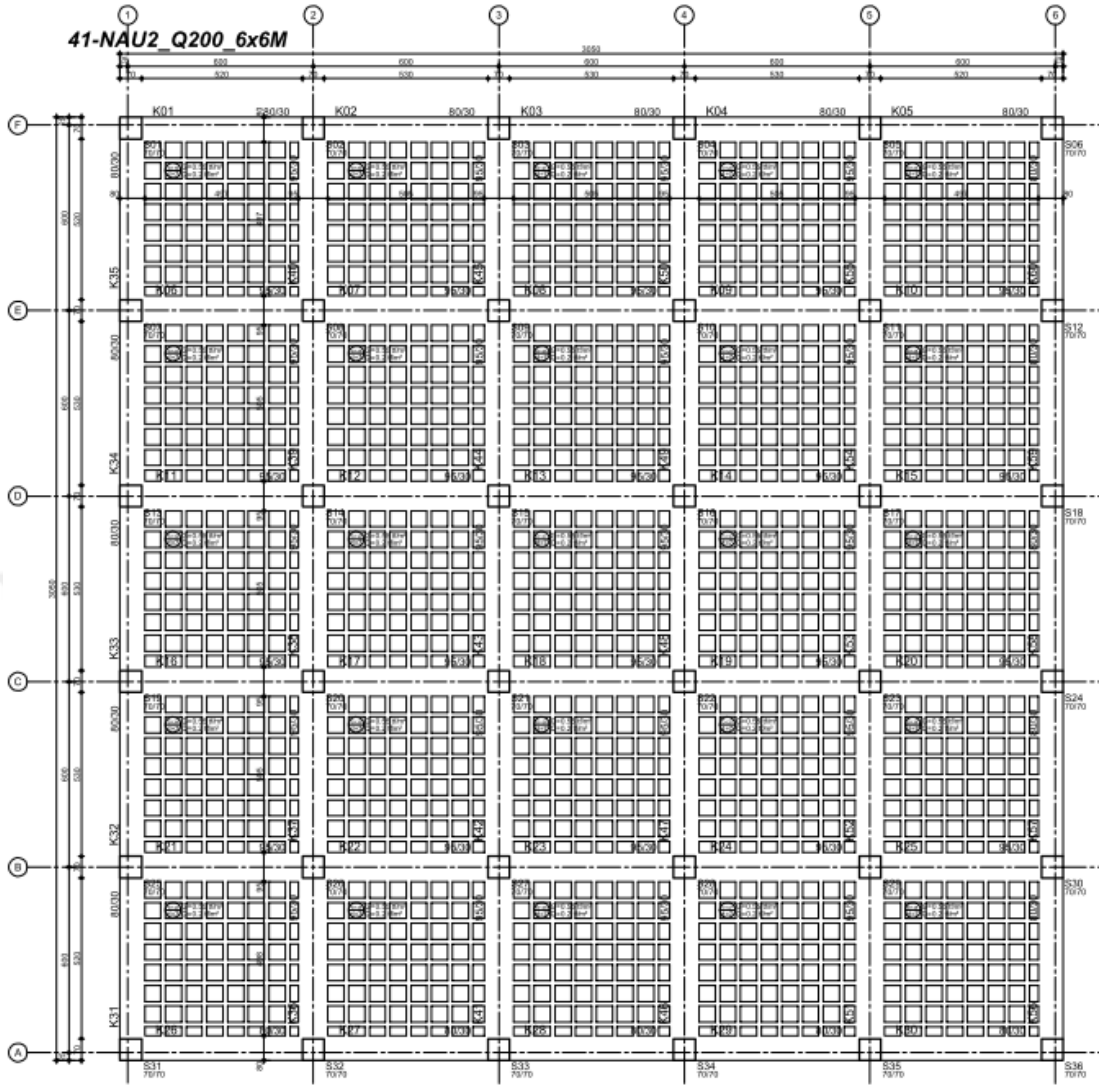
Başlıksız kirişsiz döşeme kalıp planı
